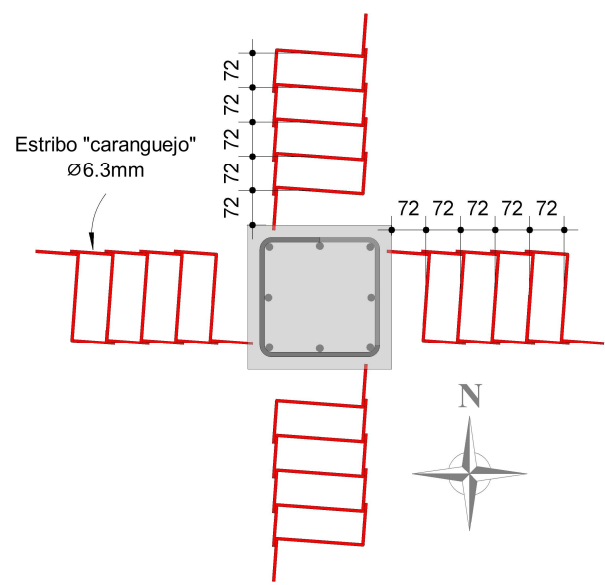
Detalhamento da armadura de cisalhamento em planta
